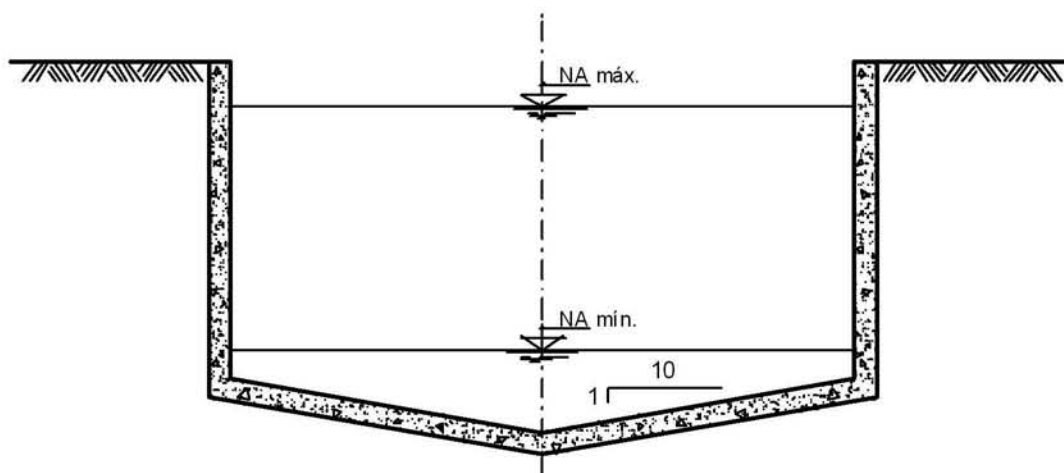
Canal en hormigón - Sección rectangular mixta
